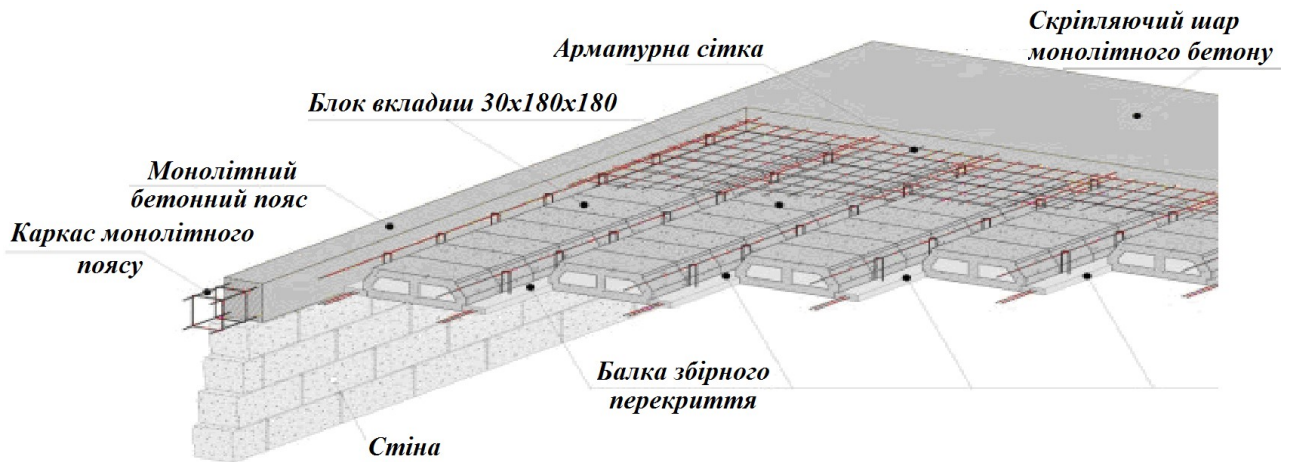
Схема облаштування збірно-монолітного перекриття
